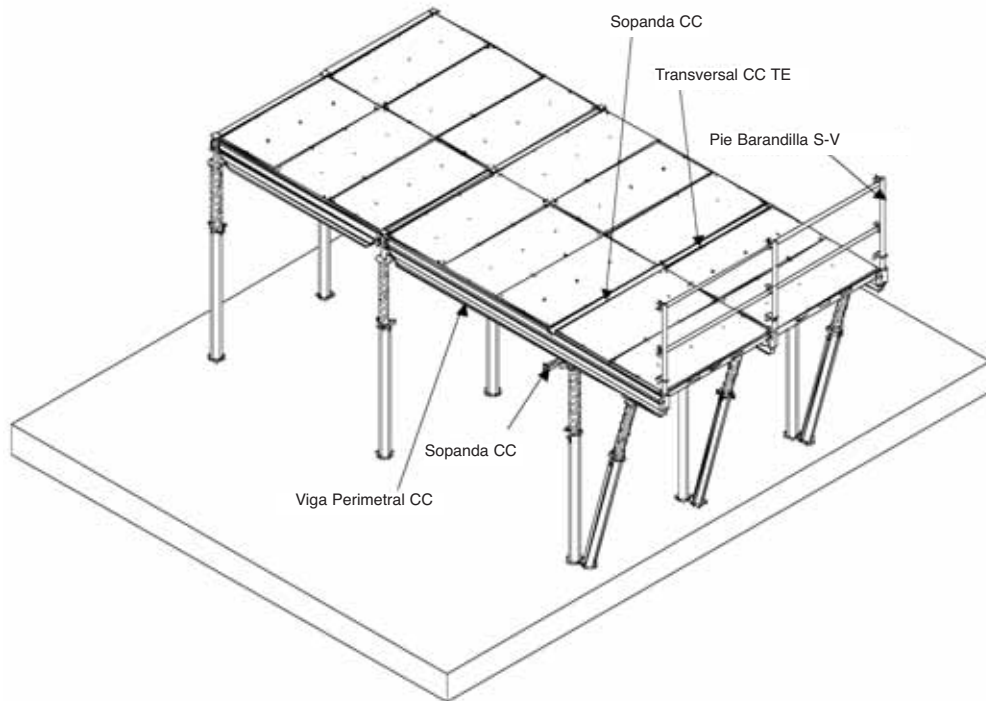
VIGAS PERIMETRALES CC en la dirección de las VIGAS CC
